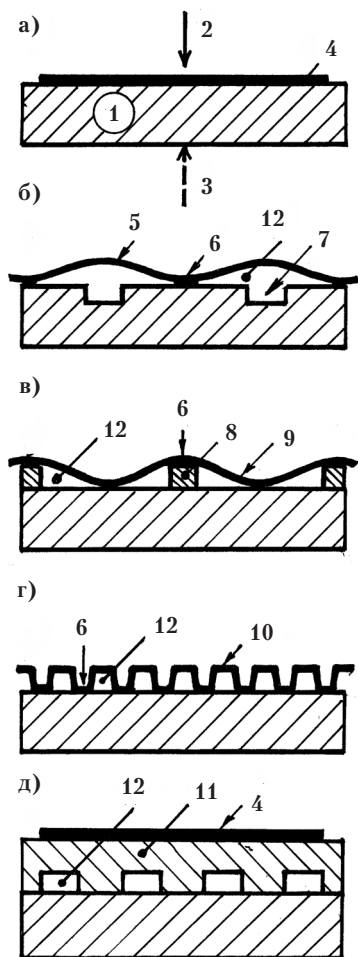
Иллюстрация принципа вентилируемой гидроизоляции: а – невентилируемая конструкция, б– д – примеры вентилируемых конструкций. 1 – водопроницаемая конструкция, защищаемая от увлажнения (бетонный фундамент, деревянная обрешётка крыши, деревянный каркас бассейна или банного сливного поддона и т. п.), 2 – направление действия воды (столба компактной воды, плёночных потоков воды, дождя и брызг, грунтовых вод, влаги в намокаемых пористых каменных материалах и т. п.), 3 – направление распространения водяных паров (из подполья, подвала, из жилого помещения и т. п.), 4 – плотно прилегающий или сплошь приклеиваемый к защищаемой конструкции листовой (рулонный) гидроизоляционный материал (битумная мастика, рубероид, гидро-стеклоизол, полиэтиленовая и поливинилхлоридная плёнка и т. п.), 5 – гидроизоляционный материал перфорированный (для защиты от брызг) или обычный неперфорированный (для защиты от воды), 6 – места перфорации, заполняемые мастикой при укладке второго слоя изоляции, или места точечной приклейки обычного материала методом предварительного точечного нанесения мастики на защищаемую поверхность, 7 – пропилены, выемки, канавки на поверхности защищаемого материала (для гарантированного образования продухов 12), 8 – сетка, рейки, планки (рёбра жёсткости для образования каналов-продухов 12), 9 – усиленный рулонный гидроизоляционный материал, 10 – тисненый гидроизоляционный материал, сам образующий продухи (например, фундалин – жёсткий чёрный полиэтилен низкого давления толщиной 0,6 мм с высотой выпуклостей 0,8 мм), 11 – утеплитель (например, листовой с выемками 12), 12 – каналы-продухи для вентилирования (высушивания) защищаемого материала внешним атмосферным воздухом.
